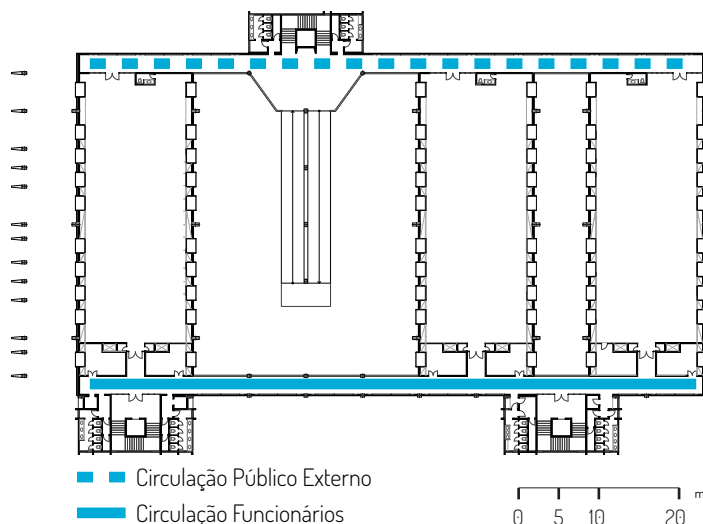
Pavimento tipo: três blocos articulados por três torres de circulação
